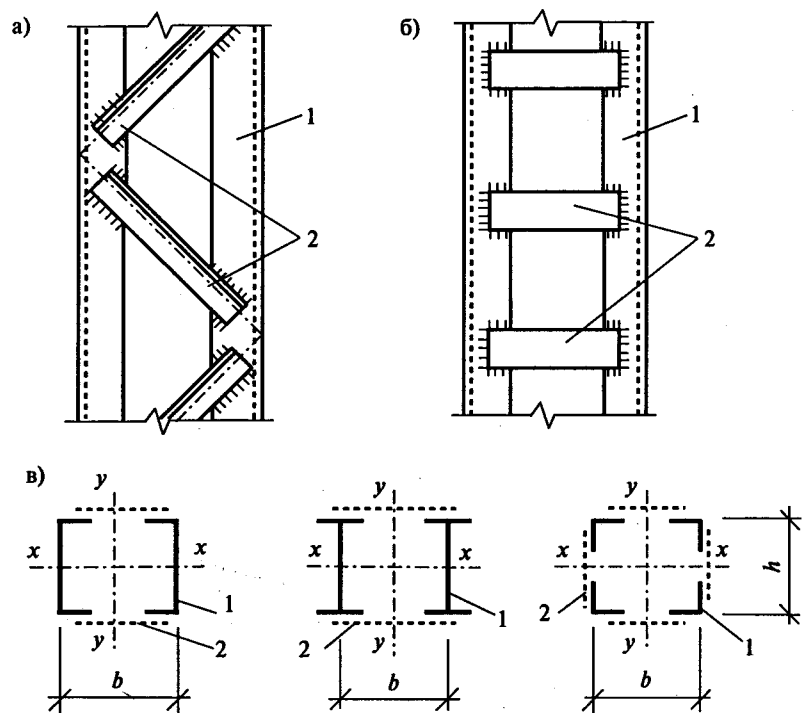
Сквозные колонны: а) решетка из уголков; б) соединение ветвей планками; в) сечения сквозных центрально-сжатых колонн; 1 — ветвь колонны; 2 — соединительная решетка
